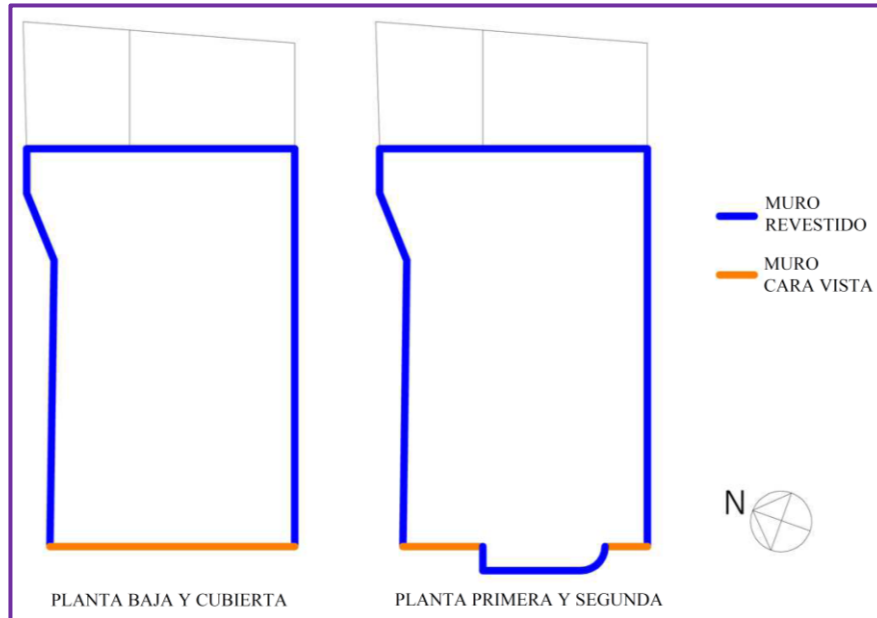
Tipologías de fachada (Fig.4.66 de Facchini, 2014)
